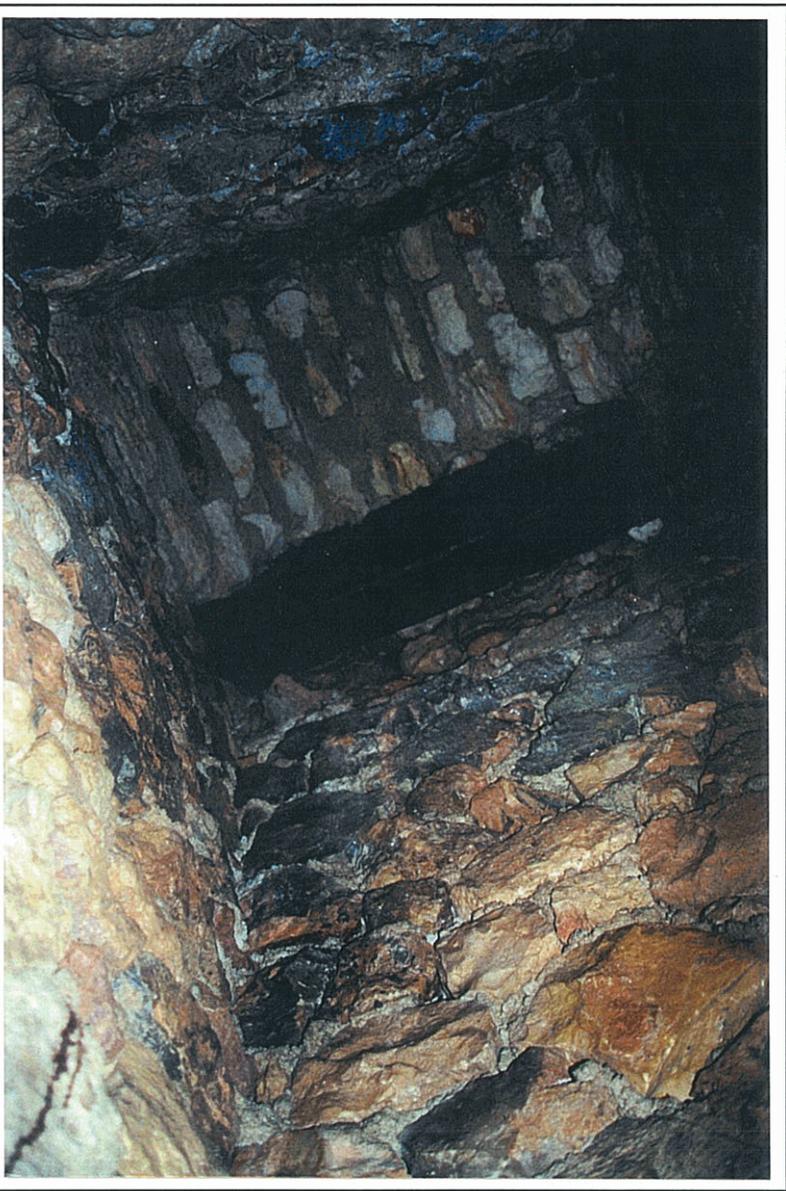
extrémité N-W de la galerie supérieure (ancien puits d'accès condamné).
